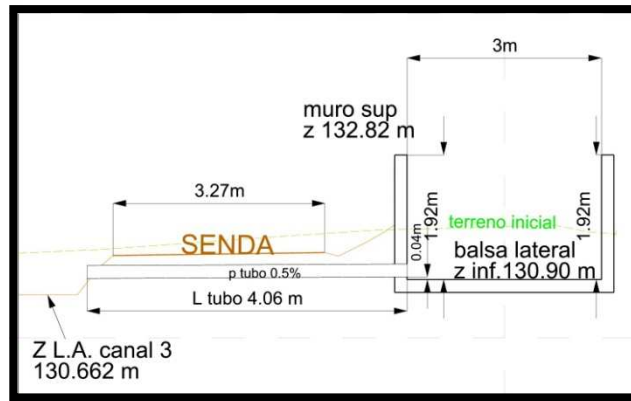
Perfil detalle conexión balsa lateral con canal 3.
